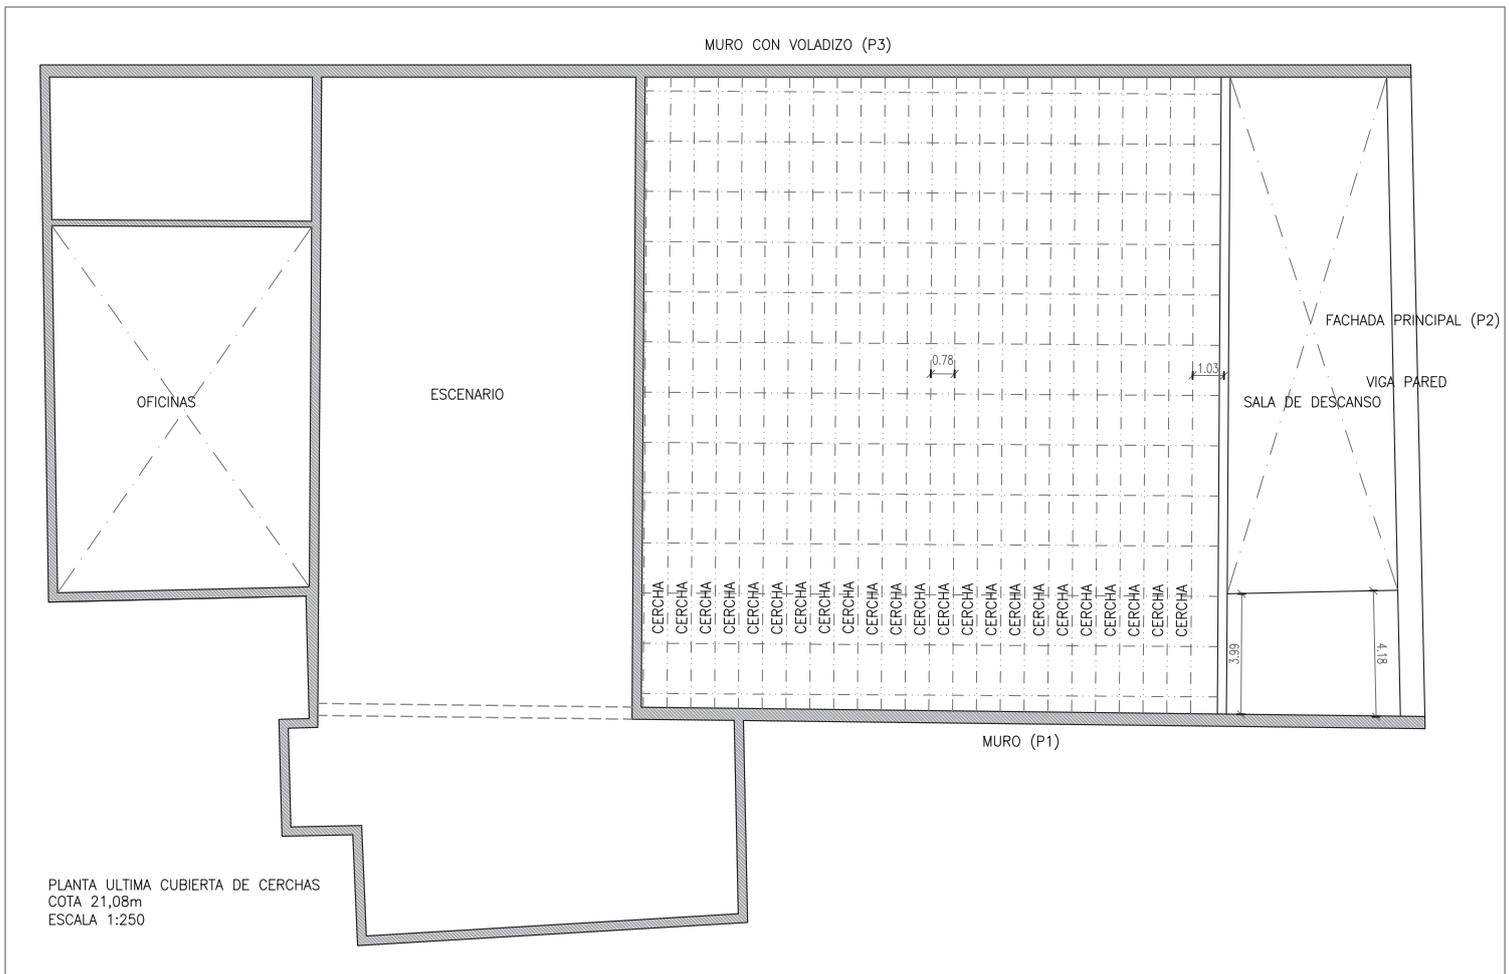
Planta situación de las cerchas. Escala 1:250 [27]
